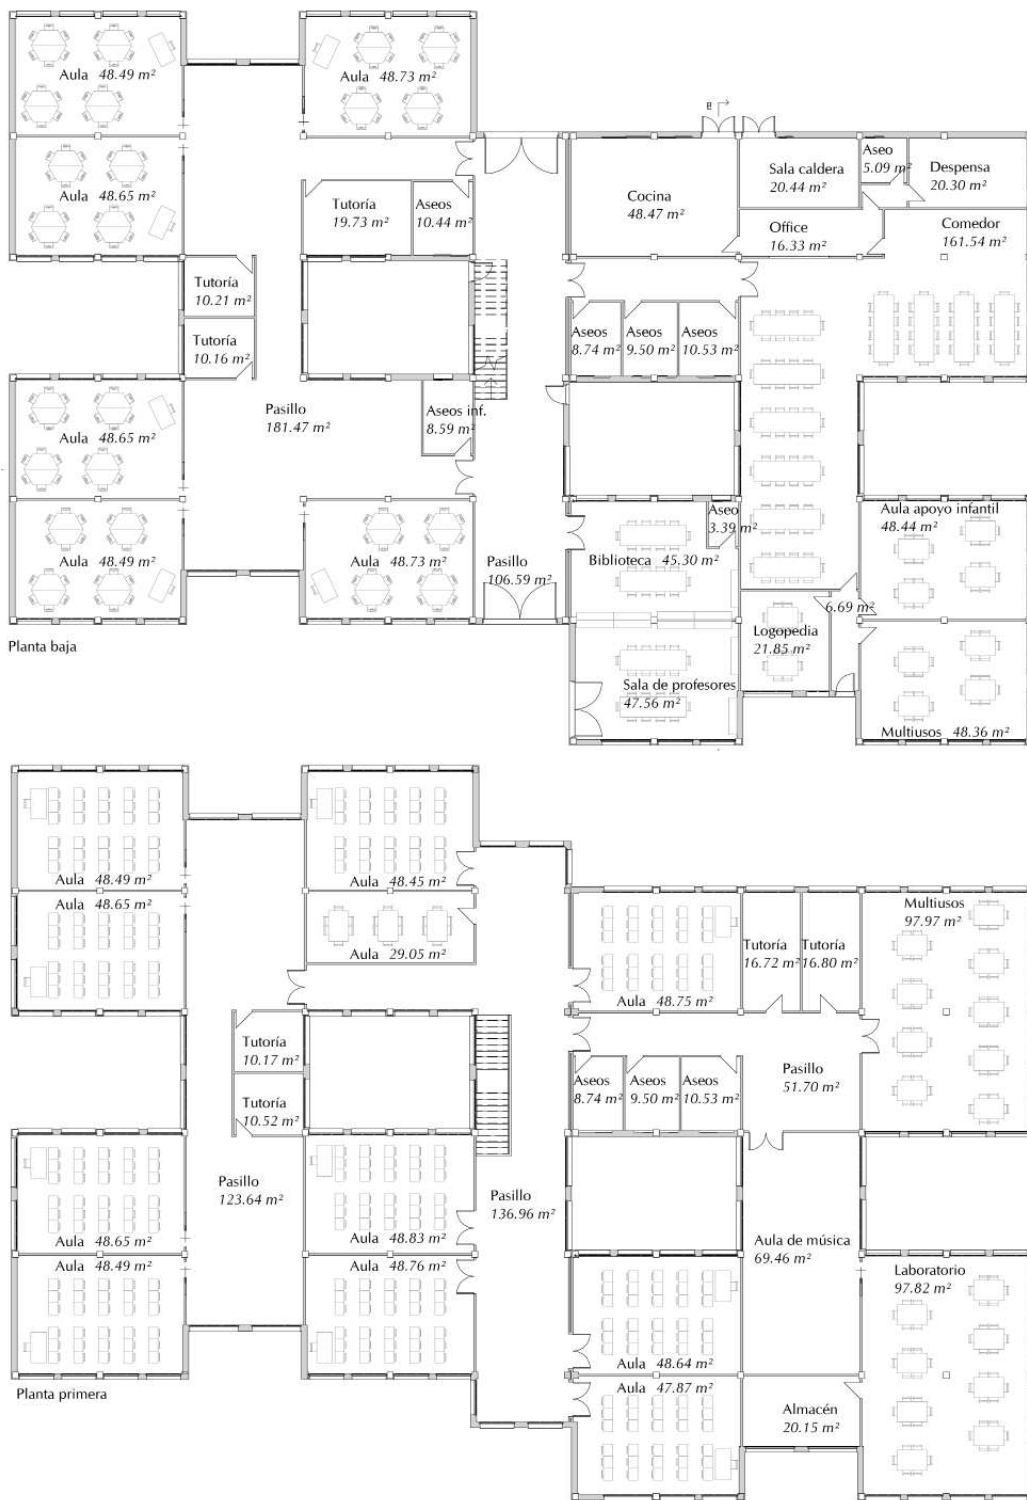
CEIP Magisterio Español: plano de planta baja y planta primera (estado actual). Fuente: elaboración propia.
